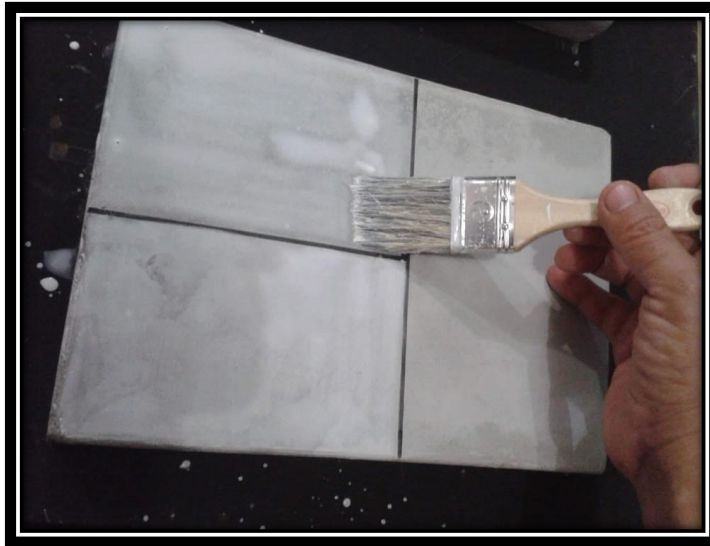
Herramientas para sellado de la segunda muestra.
